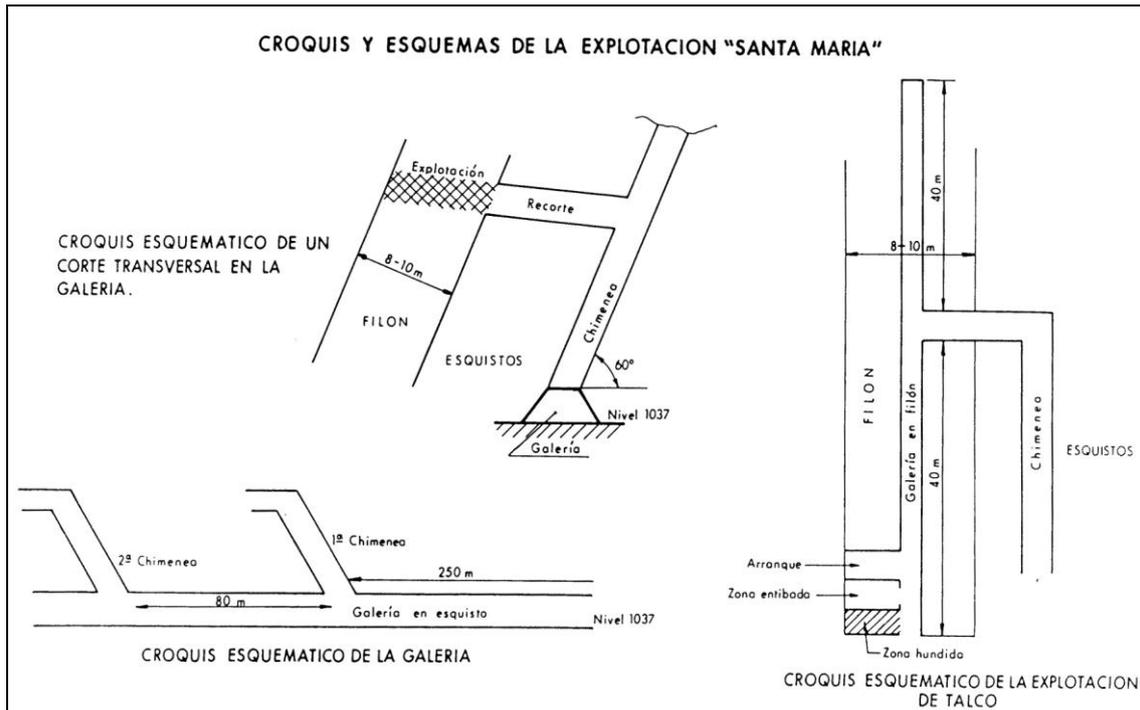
Plano de la mina Santa María (Inv. Nac. del Talco, 1984)
